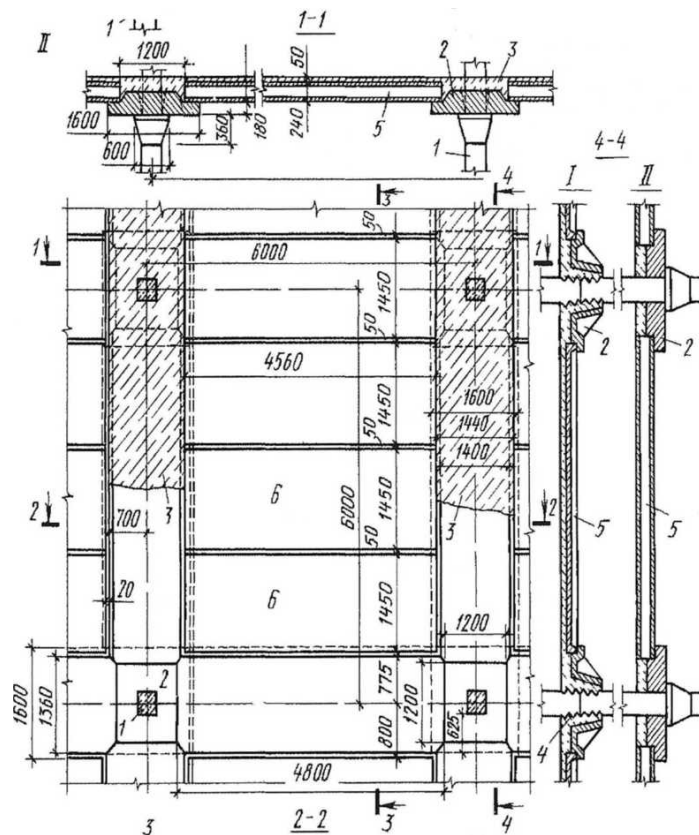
Збірно-монолітне безбалкове перекриття I - з ребристих плит, II - з
